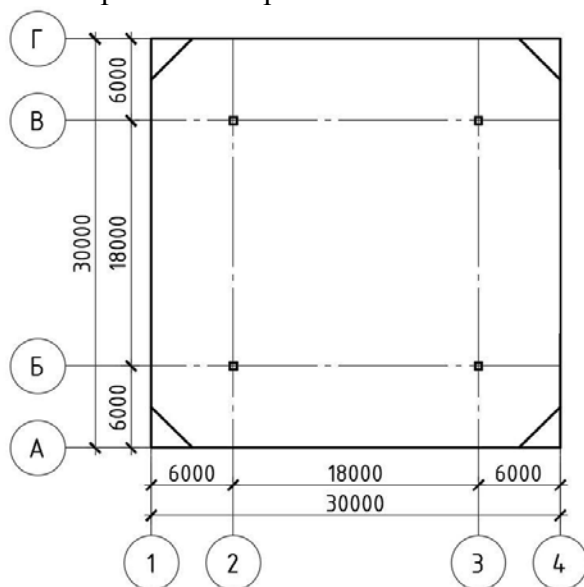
Мембранное покрытие с опиранием покрытия на колонны мембранной
